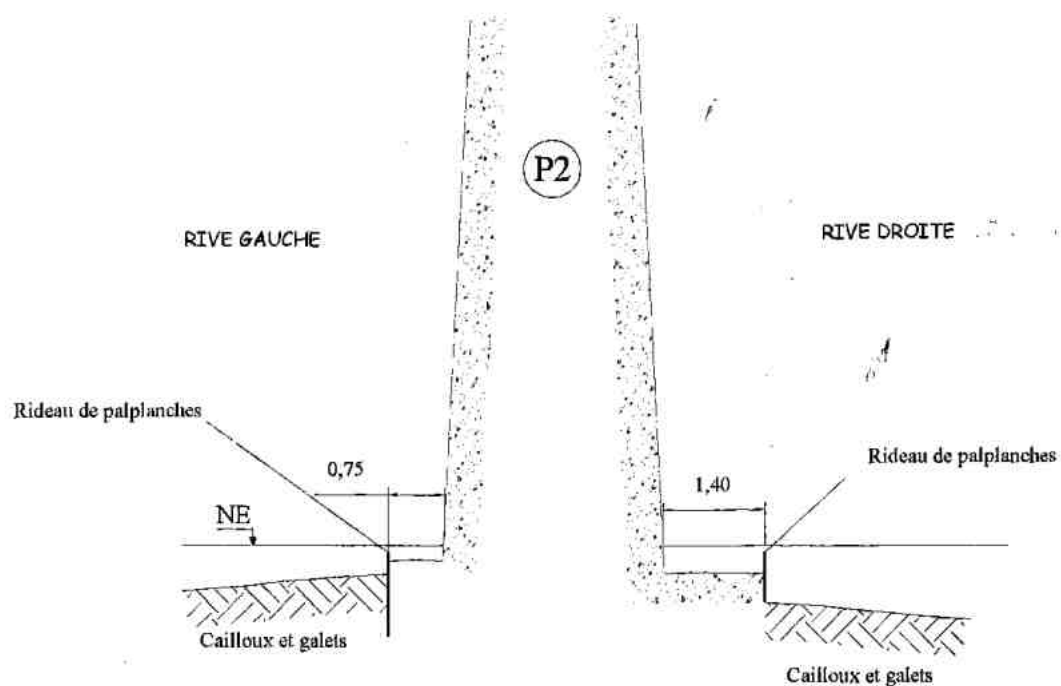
Coupe AA de la pile n°2 (CG, 2008)
